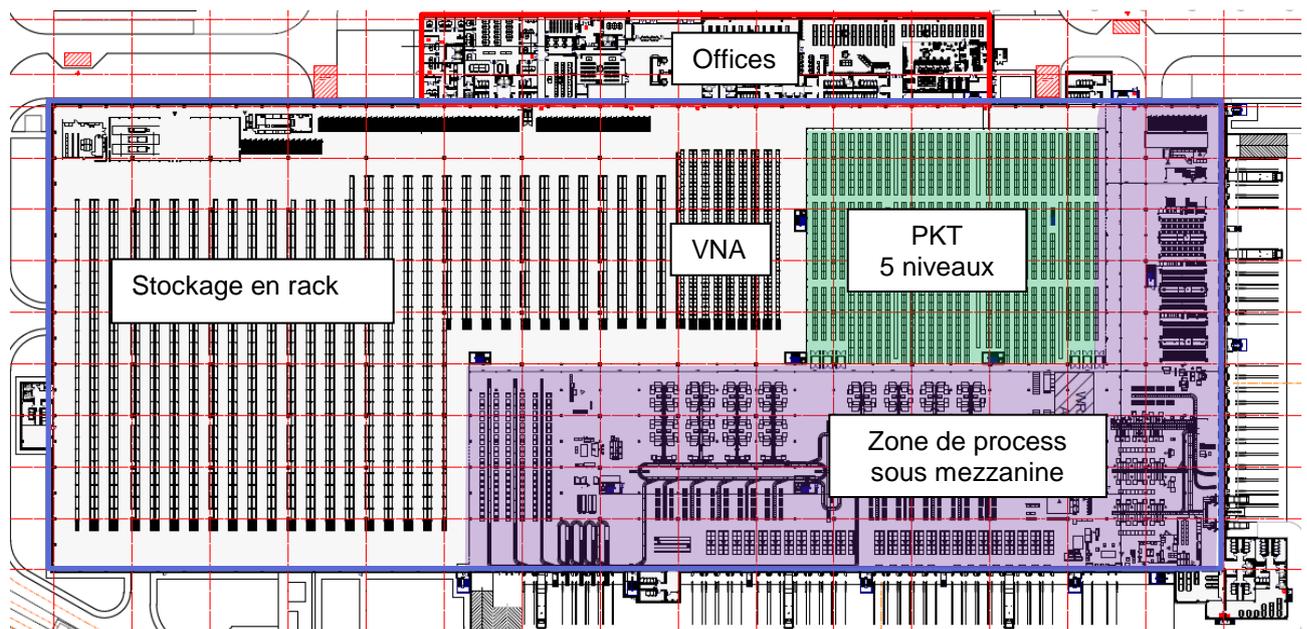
Plan du niveau RDC – P1 (+0,00 m)
